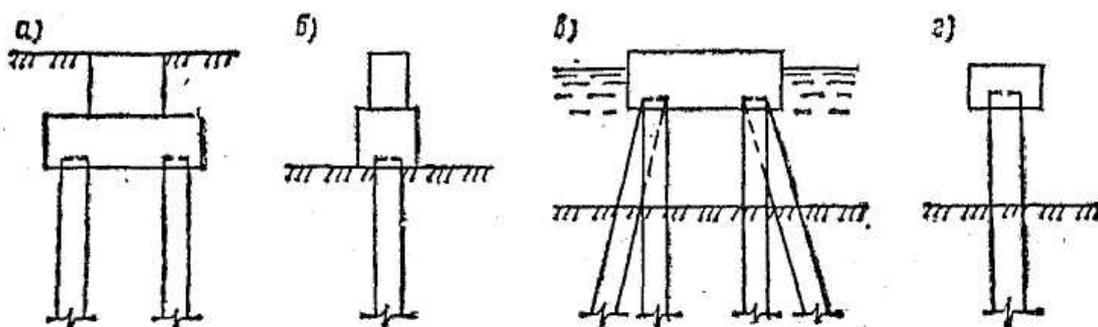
Типы свайных ростверков: а – низкий; б – повышенный; в, г – высокий
